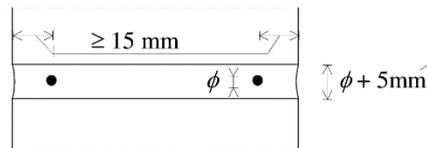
Position de l'armature pour joints horizontaux dans le joint
